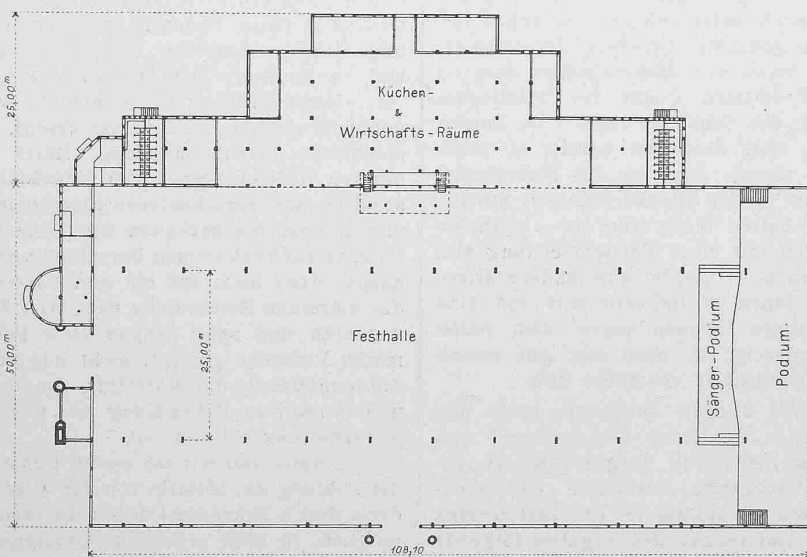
Grundriss. — Masstab 1:1000.
